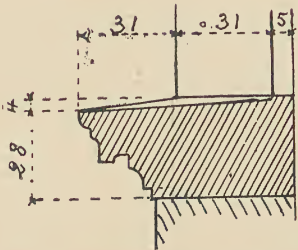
Coupe du bandeau couronnant le rez-de-chaussée.
